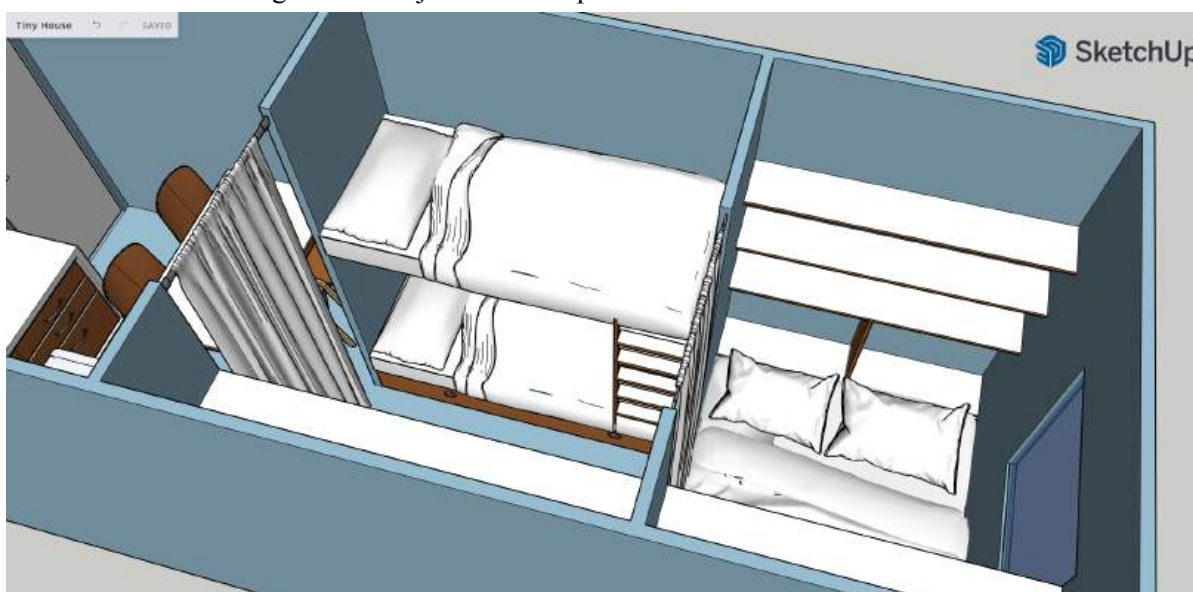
Bovenaanzicht slaapruimte 1 vanuit kastruimte
